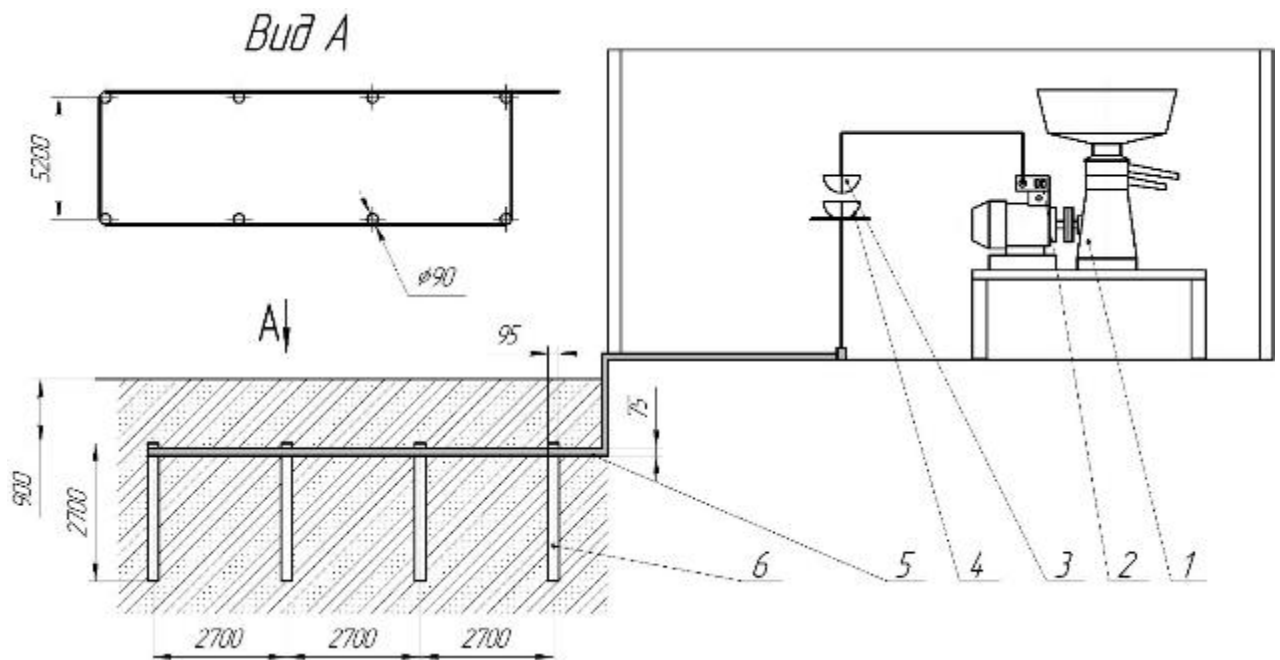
Схема контурного захисного заземлення сепаратора: 1 - сепаратор; 2 – блок керування; 3 – триполюсна електрична вилка; 4 – триполюсна розетка; 5 - горизонтальна смуга; 6 – вертикальний заземлювач
